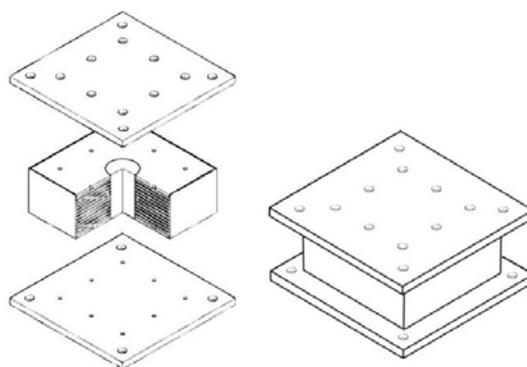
Конструкция резинометаллический опоры СВ ДШР-РСИ
